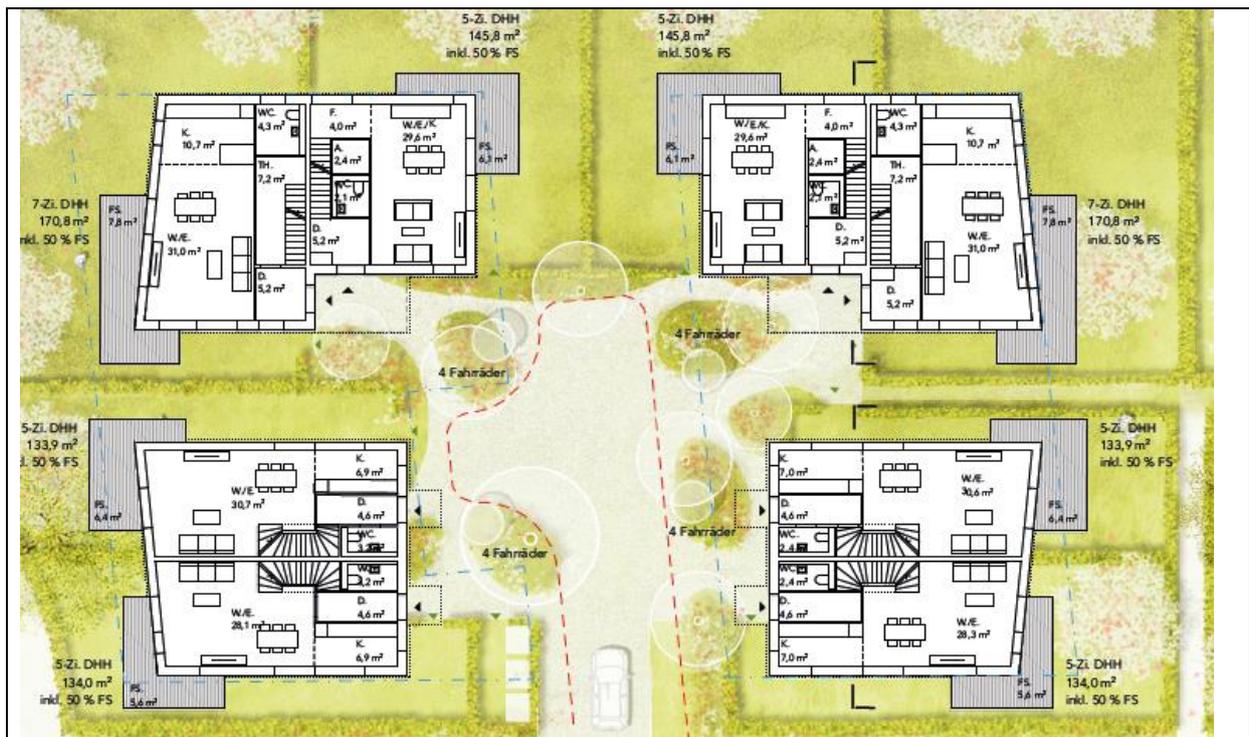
Grundrisse EG der Häuser des westlichen Wohnhofes
